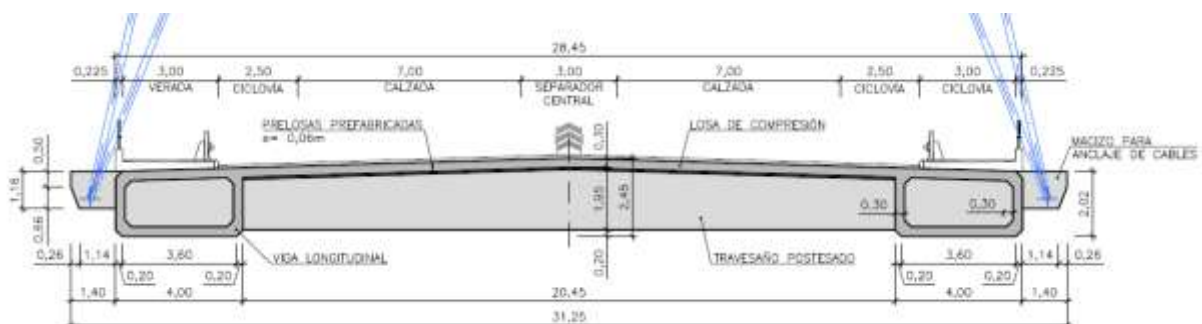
Sección tipo del tablero por riostra. Anclaje de cables
